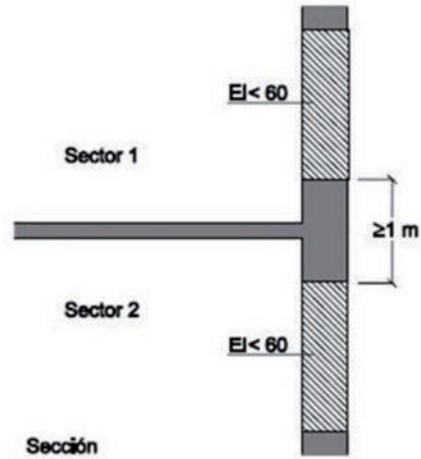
Detalle constructivo de la resistencia al fuego exigida en encuentro de forjado-fachada.
